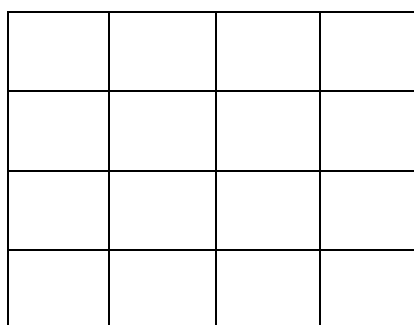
Armadura de acero corrugado de 12 mm de diámetro utilizada para losetas antiguas con espaciamiento de 22 cm aproximadamente
